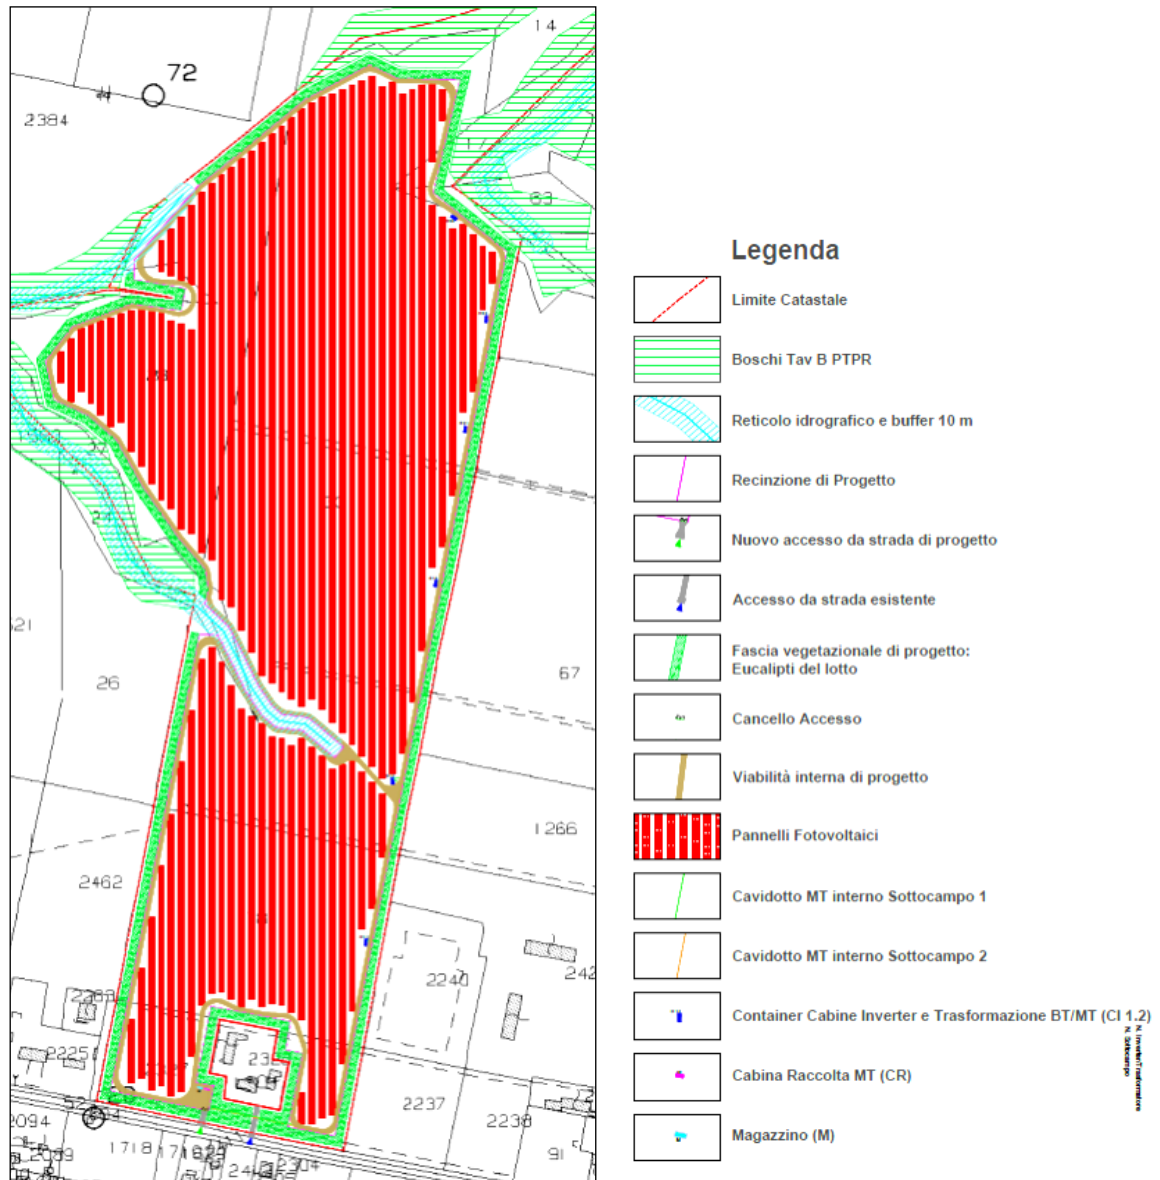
Planimetria di Progetto su Mappa Catastale - Foglio 115 - Scala 1:2000
